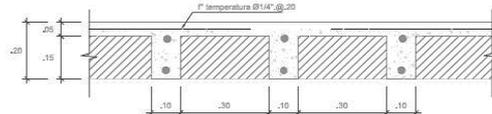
Detalle del techo aligerado VUF 04 - AC.
